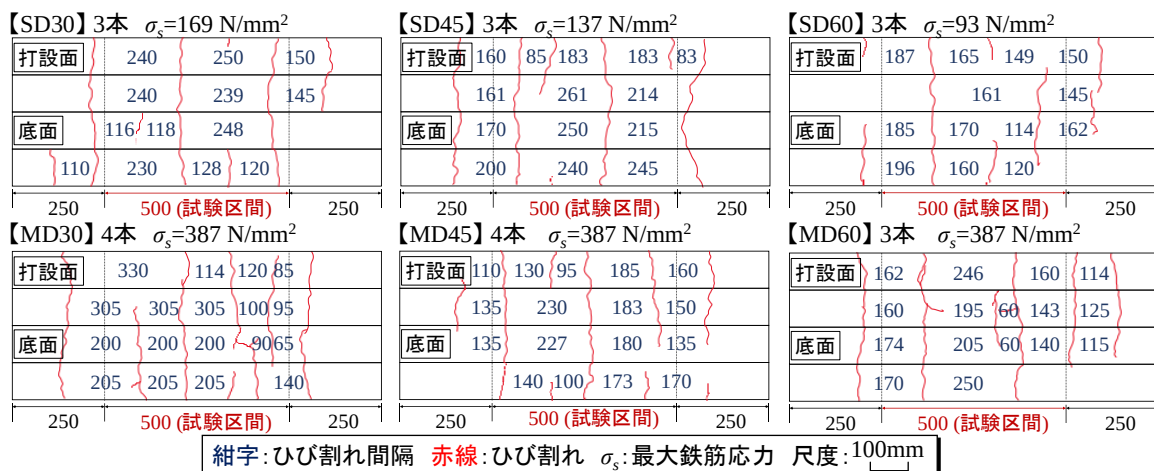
供試体表面のひび割れ発生状況 (荷重試験終了時点)
